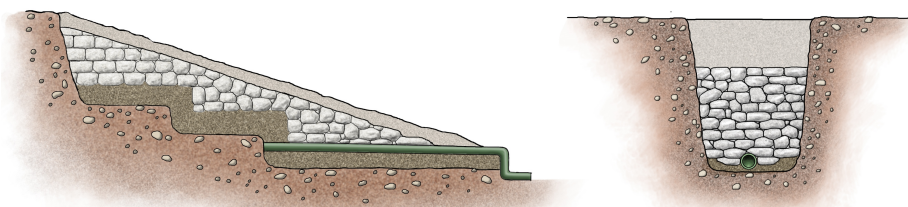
Sperone drenante realizzato in pietrame murato a secco.
